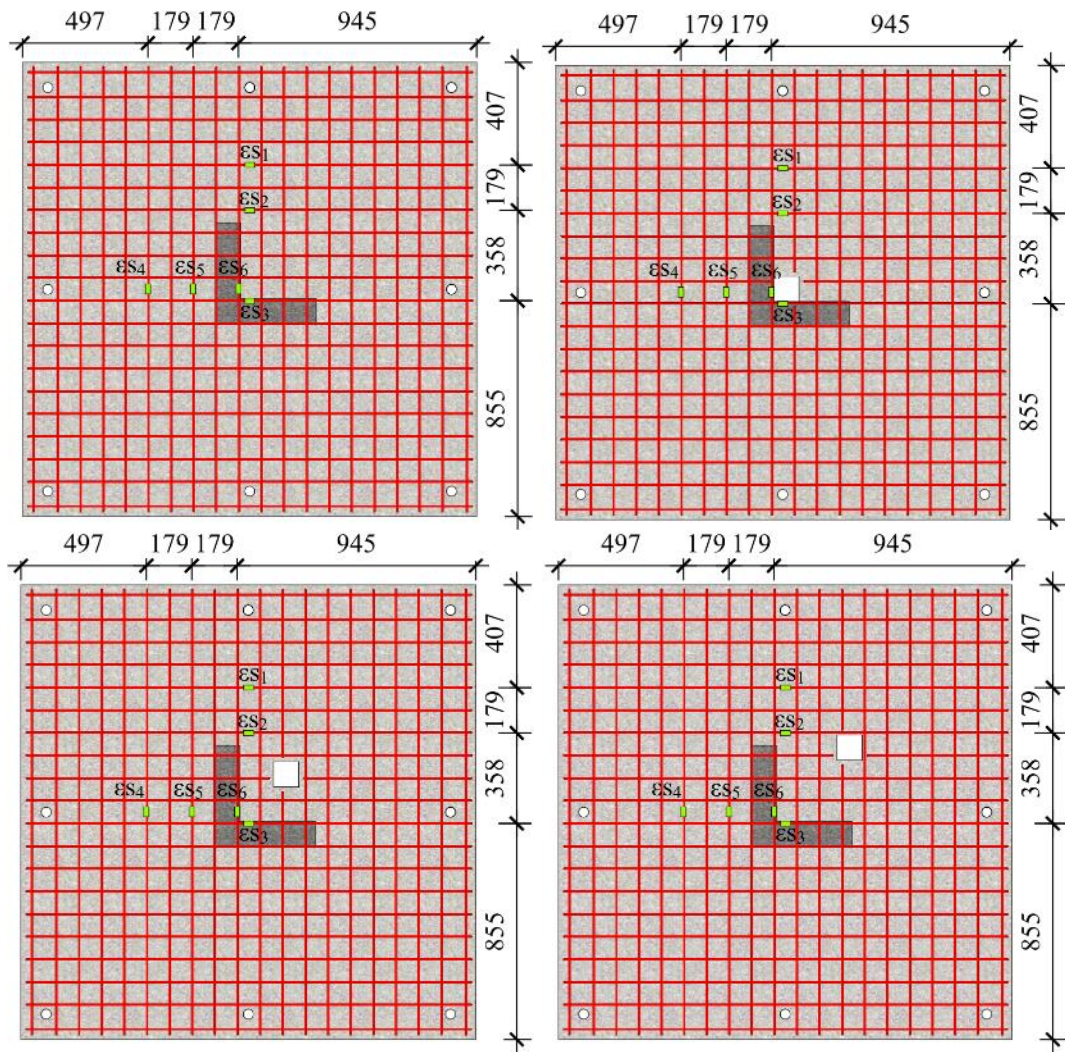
Disposição dos EERs nas armaduras de flexão
